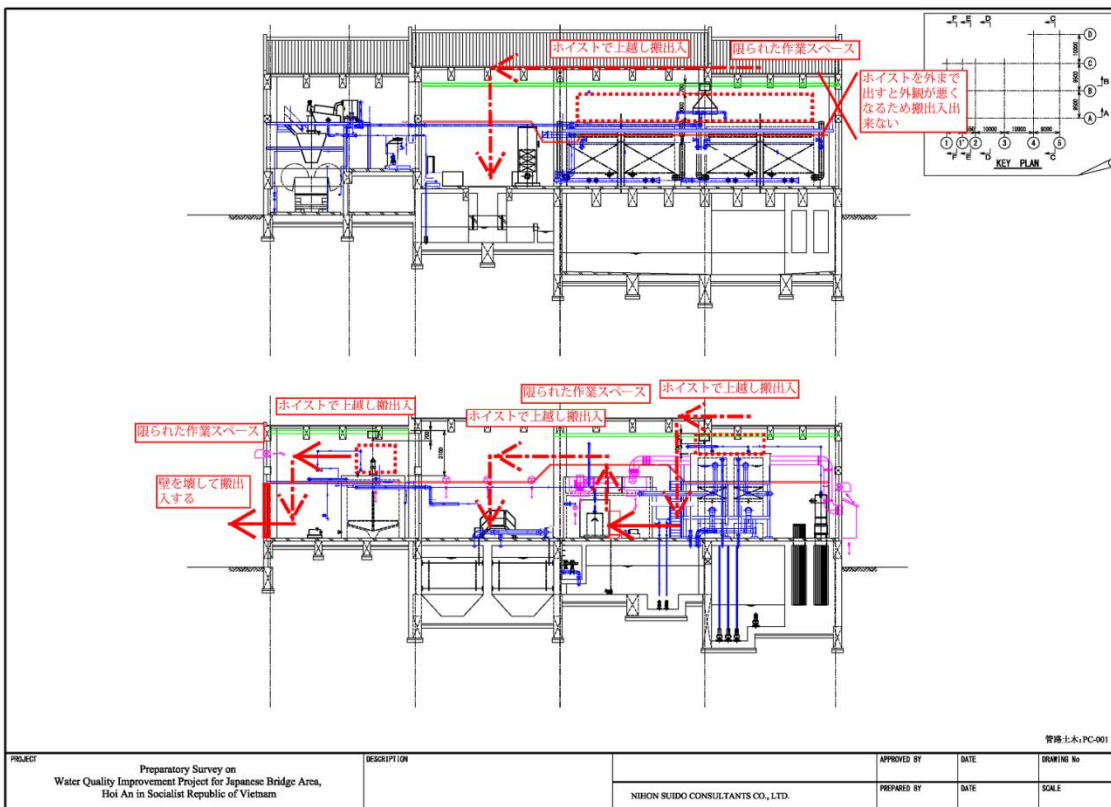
コンクリート製タンクの機器搬出入ルート（断面図 1）
